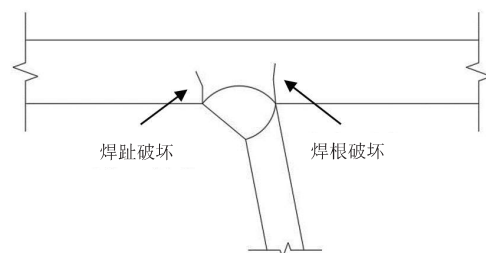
U 肋-顶板焊缝疲劳破坏类型
